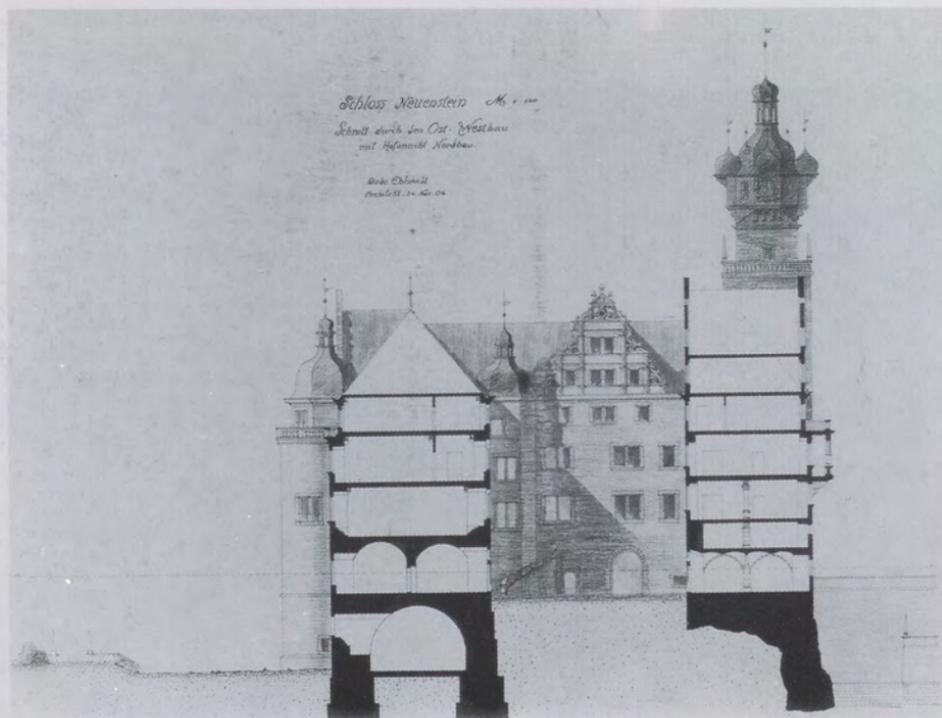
Erster Gesamtentwurf: Schnitt durch den Ost-Westbau mit Hofansicht Nordbau. (HZAN: Plan o. I.)
